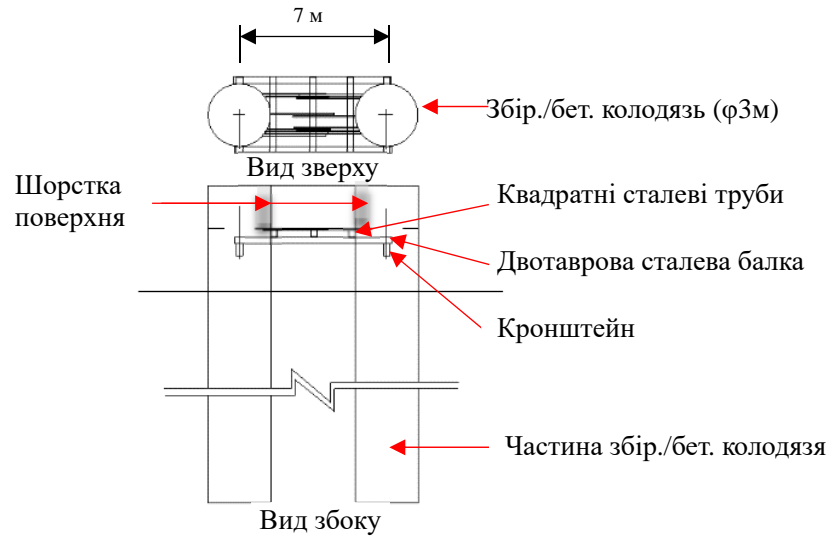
Довідкове креслення для виготовлення опорної балки
